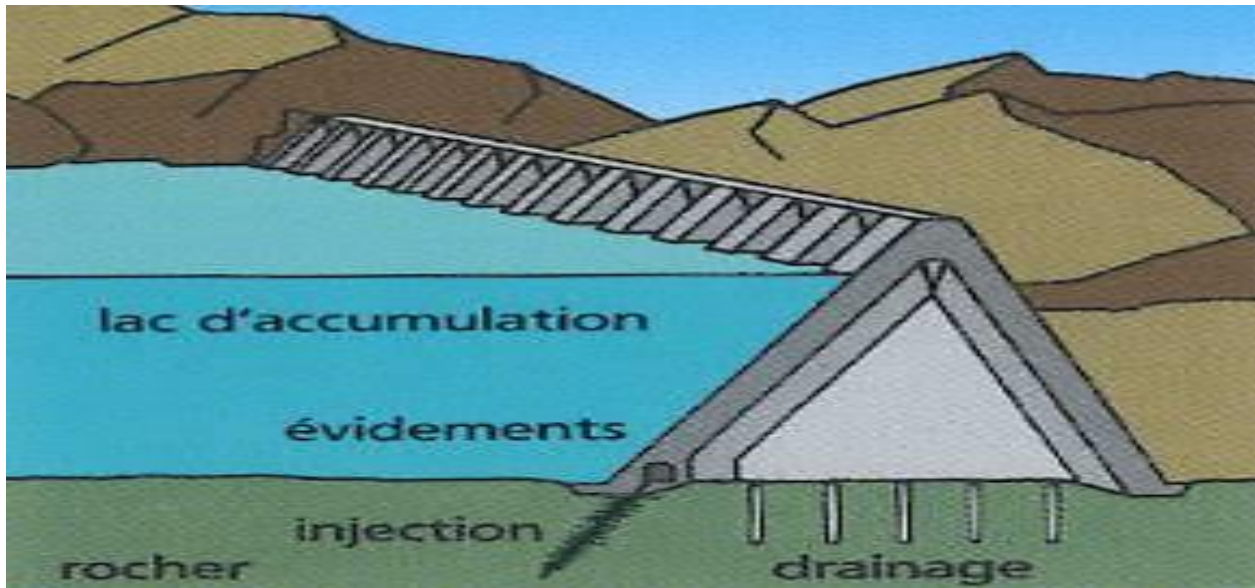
montre une Coupe d'un barrage en contrefort [4
